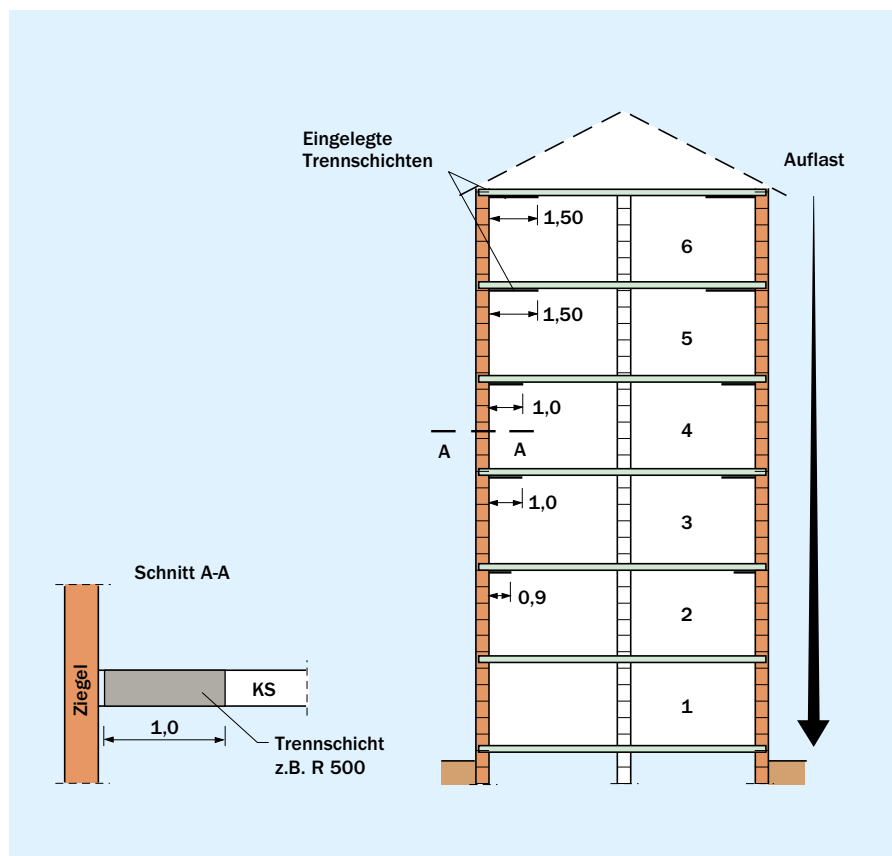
Stumpfstoßtechnik mit eingelegerter Trennschicht in der Innenwand
